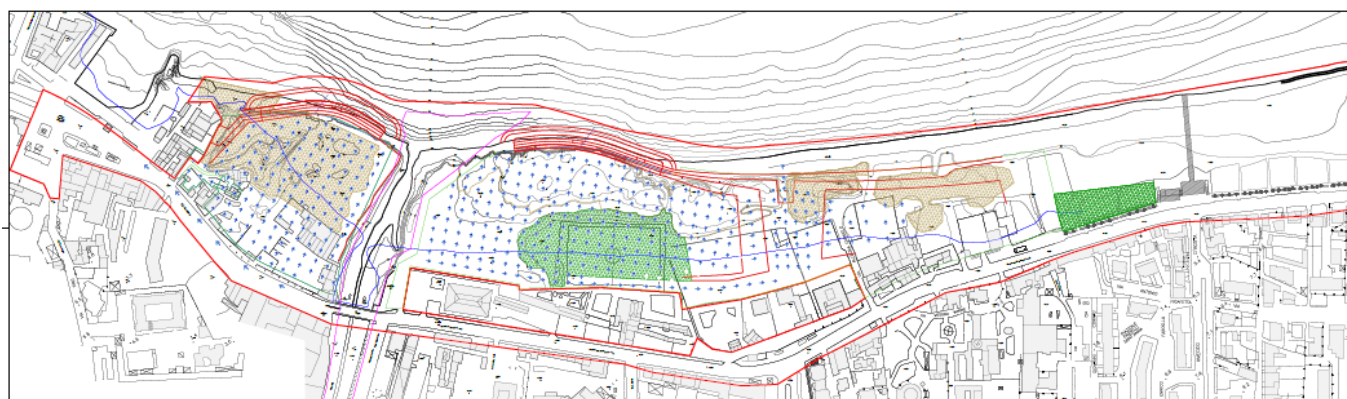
Planimetria degli interventi di mitigazione del rischio idraulico
